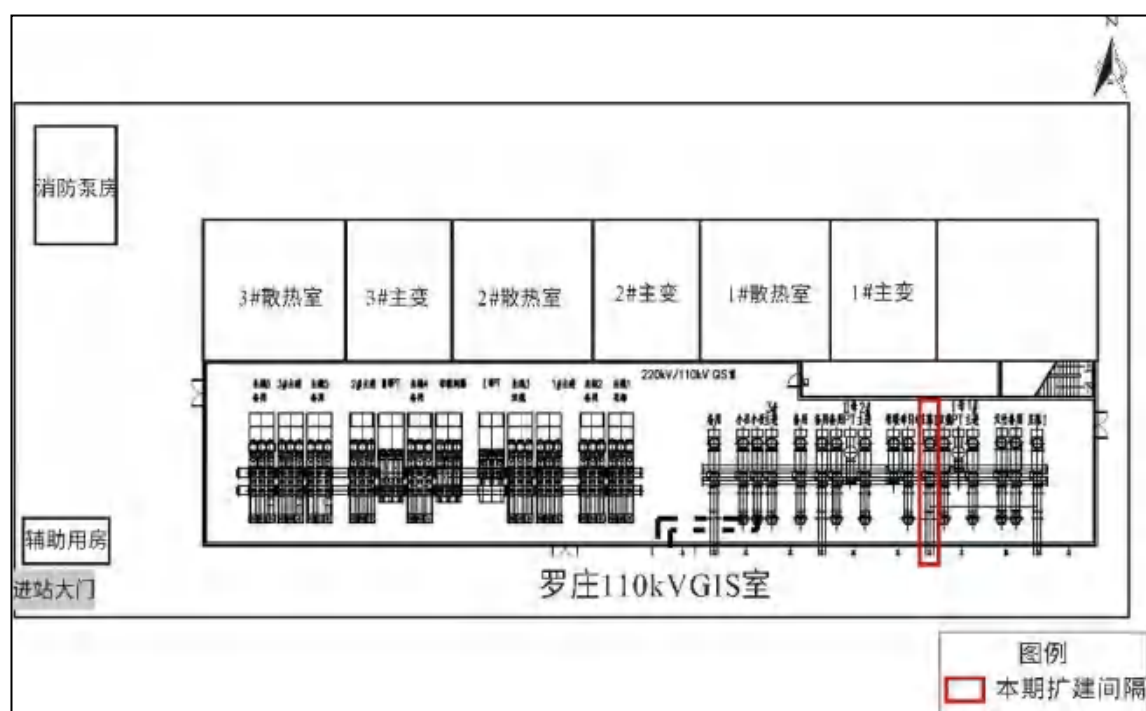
罗庄 220kV 变电站本期扩建间隔平面布置示意图
